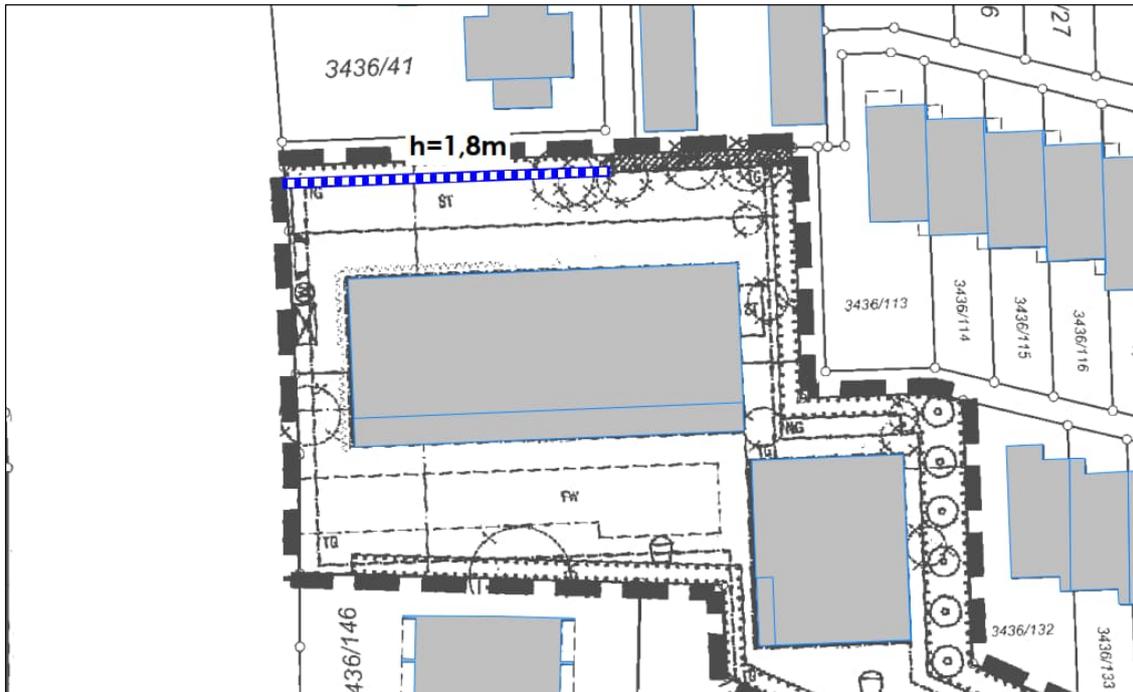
Lageplan mit Darstellung der Lage der notwendigen Lärmschutzanlage
